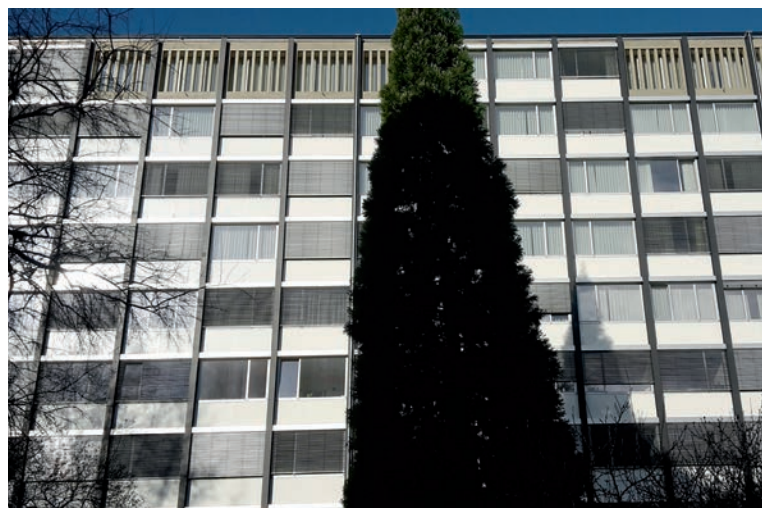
Ostfassade, Nordabschnitt, nach der Sanierung, 2017
